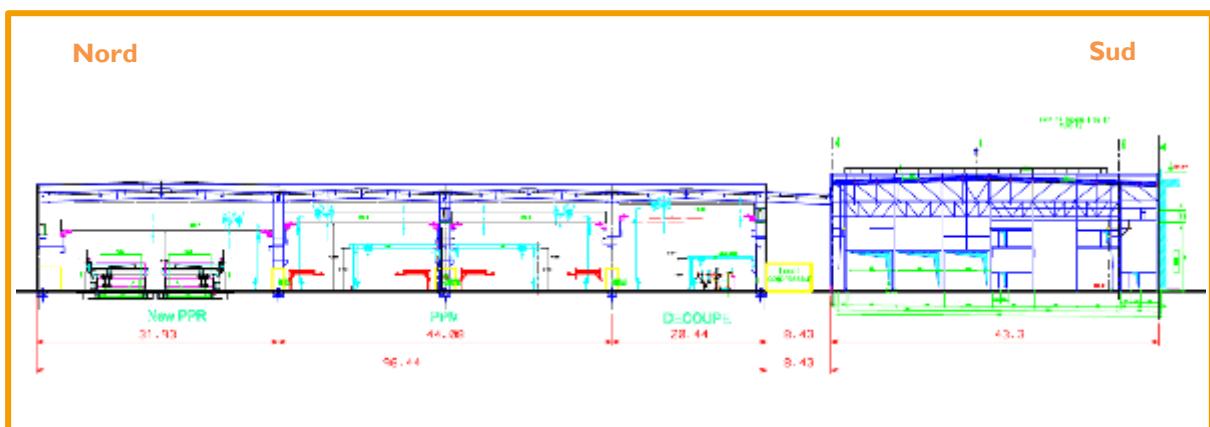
Plan de coupe du projet d'aménagement (source : Les Chantiers de l'Atlantique, daté du 23/10/2021)
